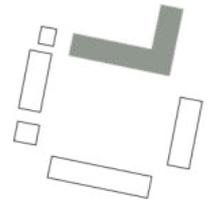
Detailansicht Ehemaliges Herrenhaus
